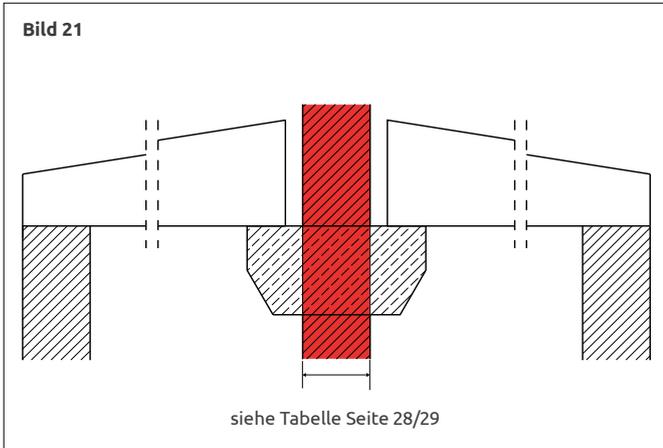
Zur Gewährleistung der Standsicherheit von Brandwänden sowie zur Verringerung des Schadenausmaßes bei einem Brand, sollten auch feuerbeständig ausgeführte Bauteile, z. B. Stahlbetonbinder, nicht durch Brandwände hindurchgeführt werden.
